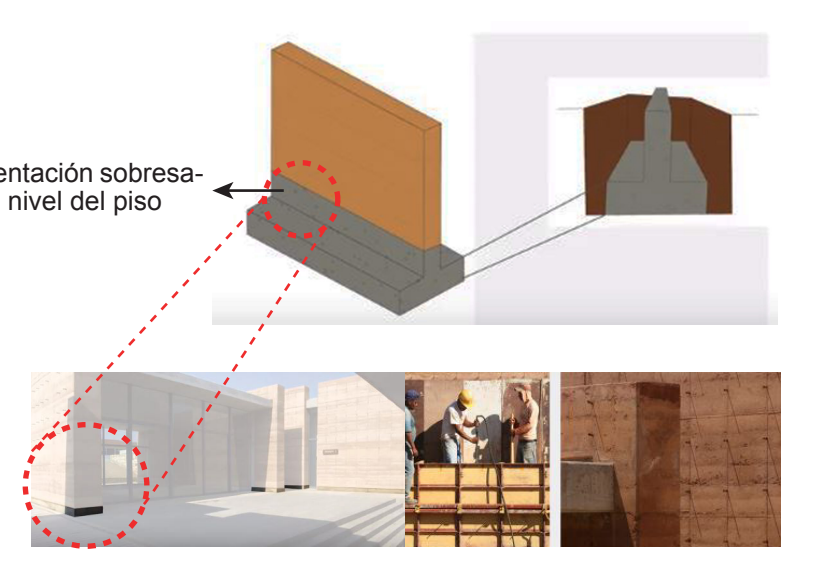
Estructura. Adaptado de (Arquitour, s.f.)
